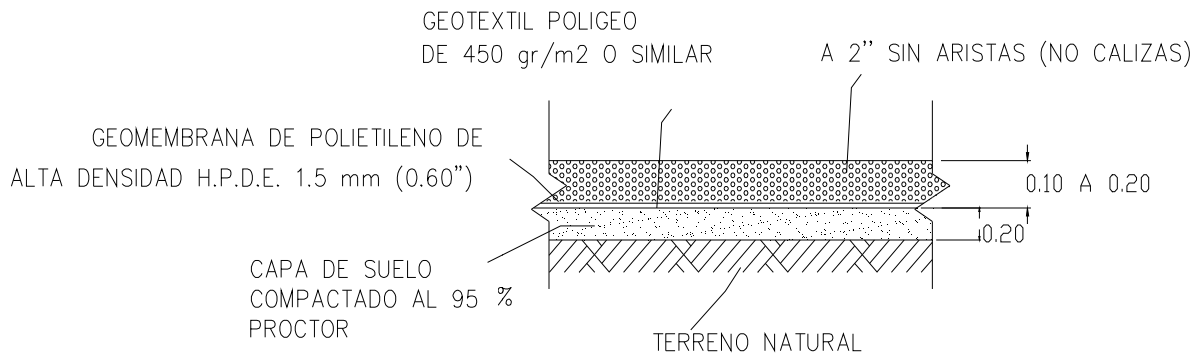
Sistema de impermeabilización artificial utilizando geomembrana
